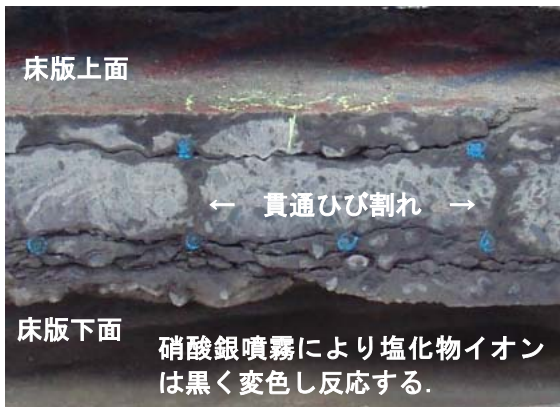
貫通ひび割れ部における硝酸銀噴霧状況
